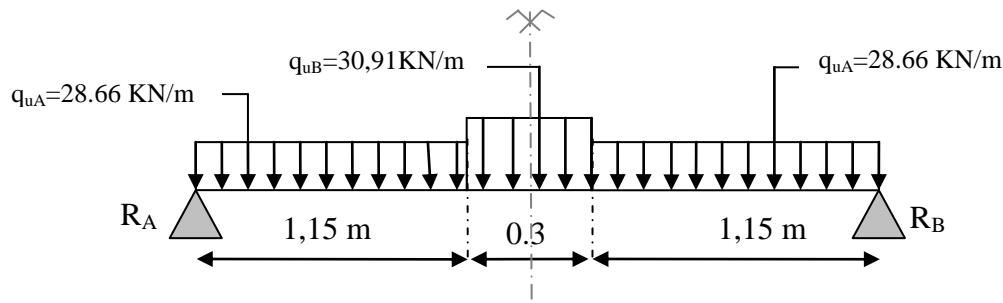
Schéma statique d'une poutre palière à l'ELU
